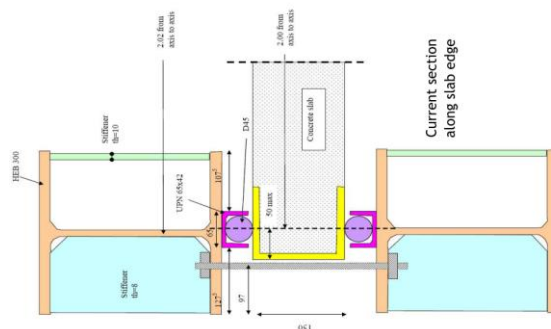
Détail des liaisons entre la dalle en béton et le cadre
